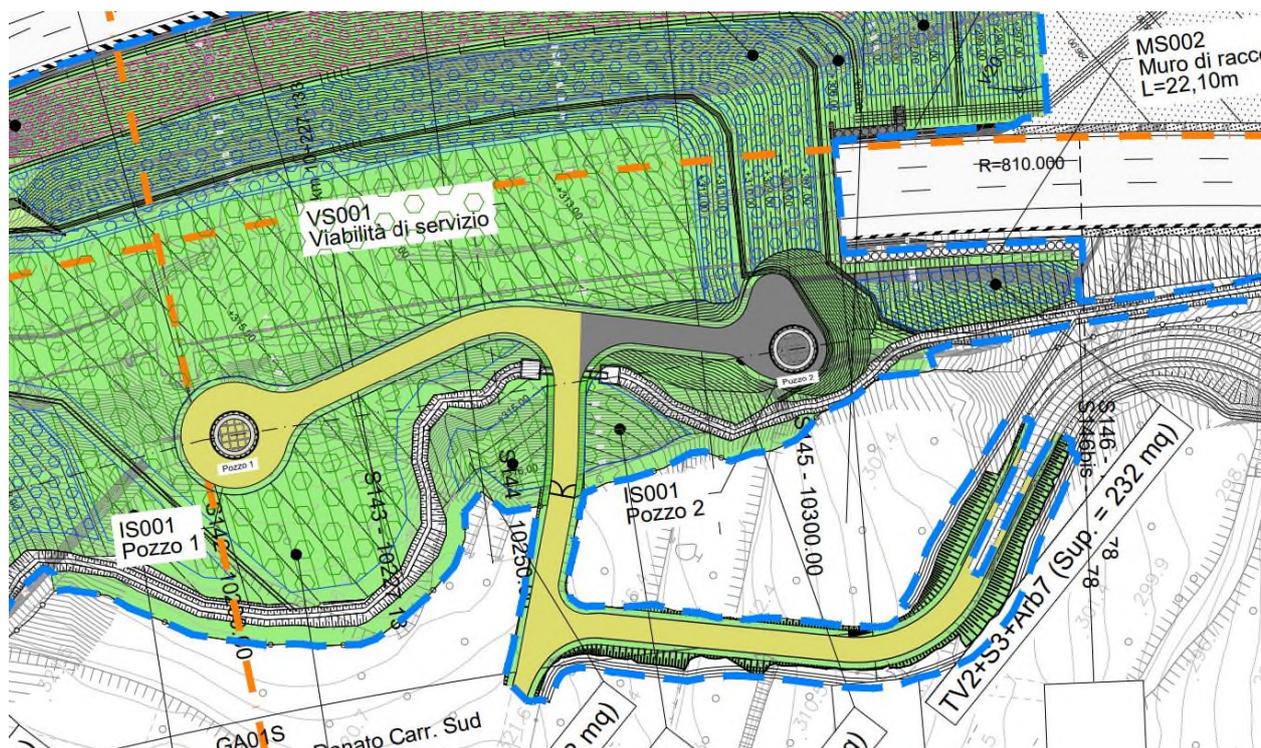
Planimetria di sistemazione definitiva: in ocre la pavimentazione permeabile con pendenze più dolci in misto granulare; in grigio la pavimentazione impermeabile a finitura bituminosa col piazzale di manovra per l'accesso al pozzo 2.
